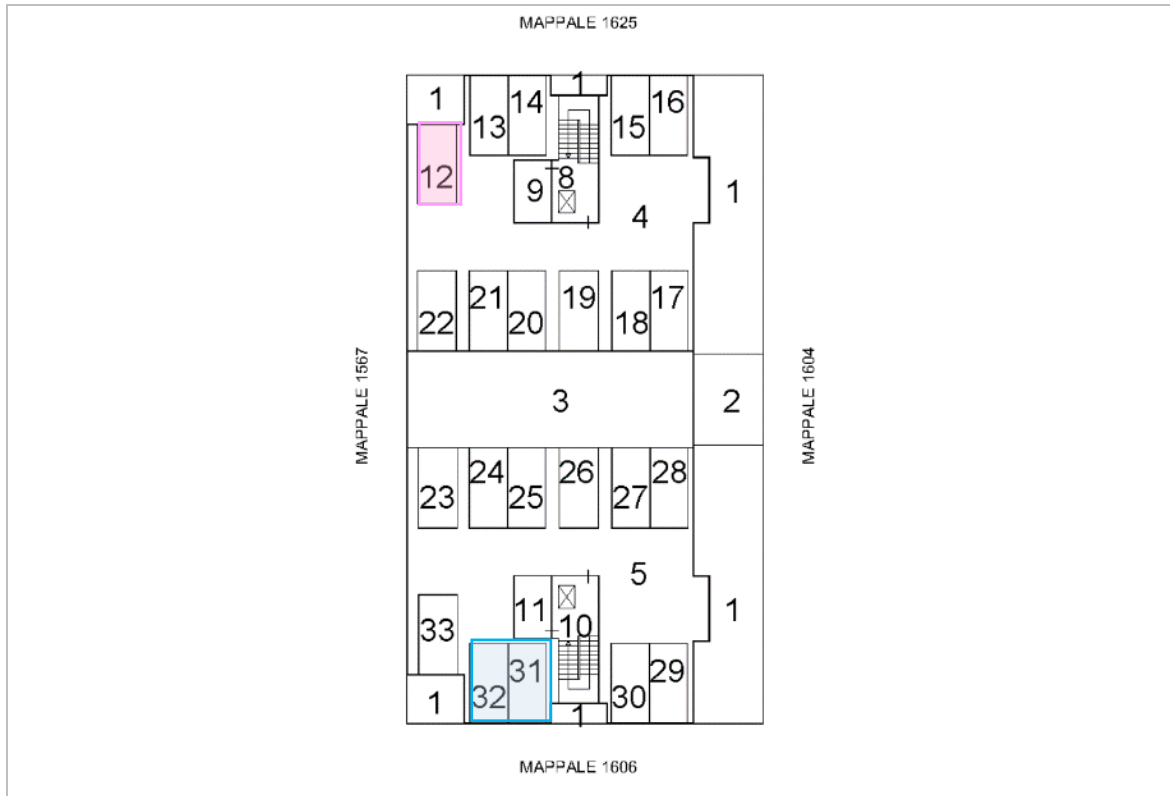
Subb. 12-31-32 (piano sottostrada)
